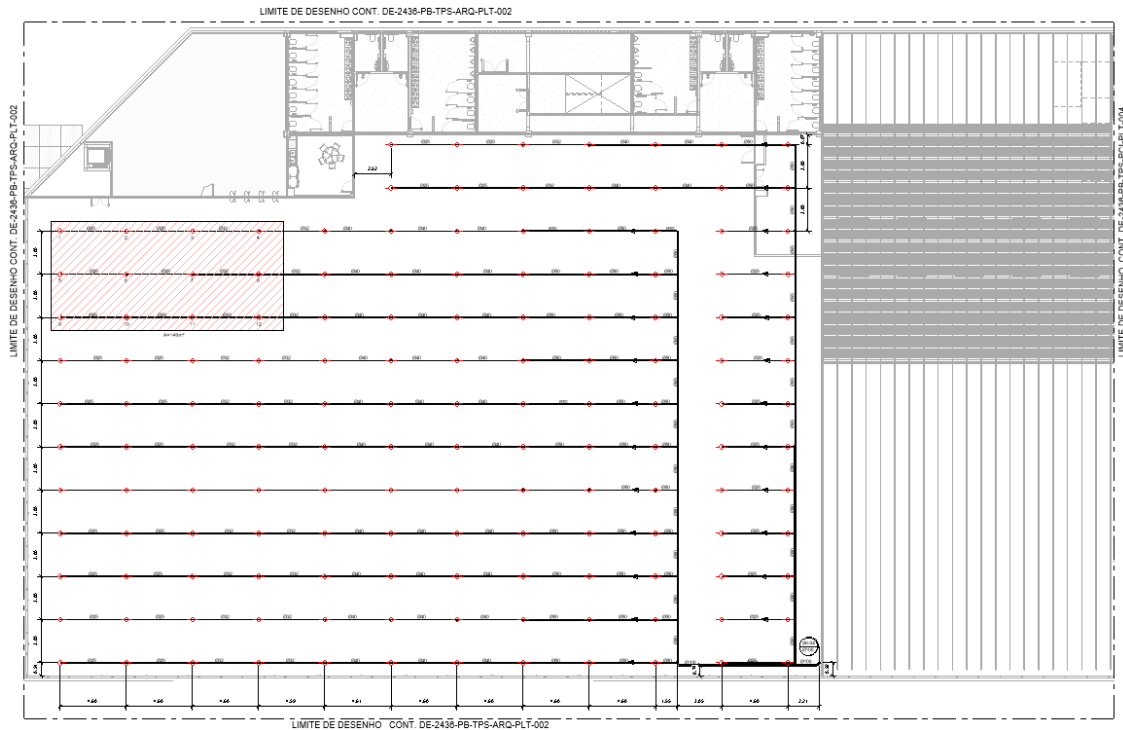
Arranjo da tubulação dos sprinklers no primeiro pavimento lado oeste (Open Space).
